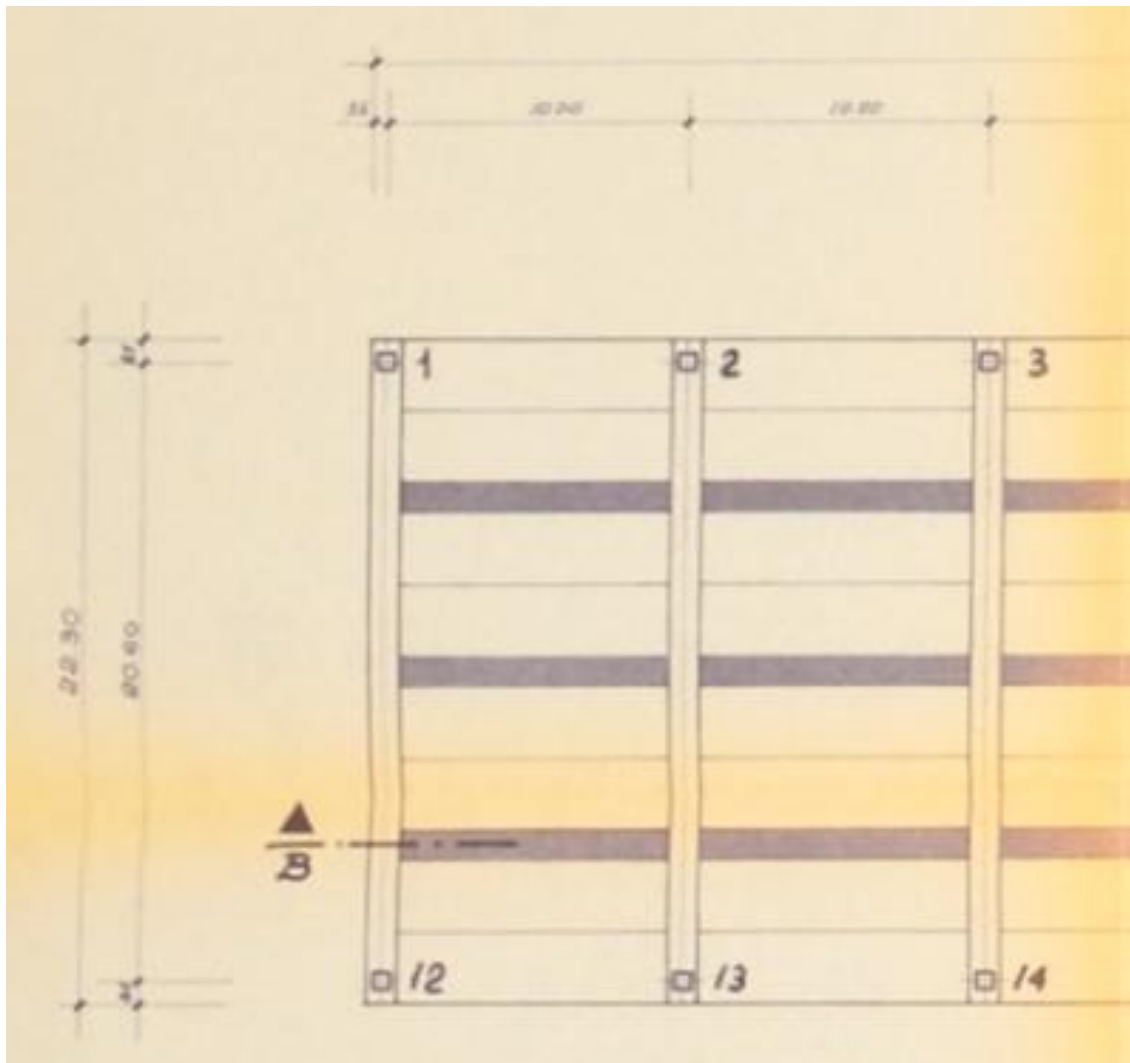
Particolare di A.1980.cap.us.T03 - Pianta e sezioni
